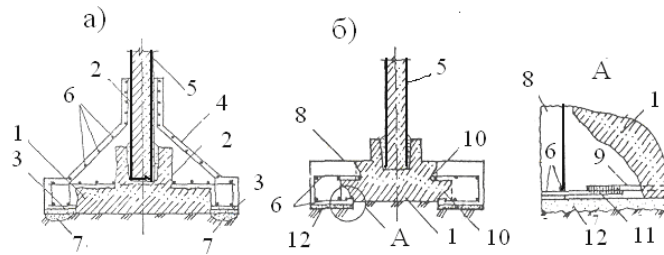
Устройство железобетонной «рубашки» и бетонного прилива
